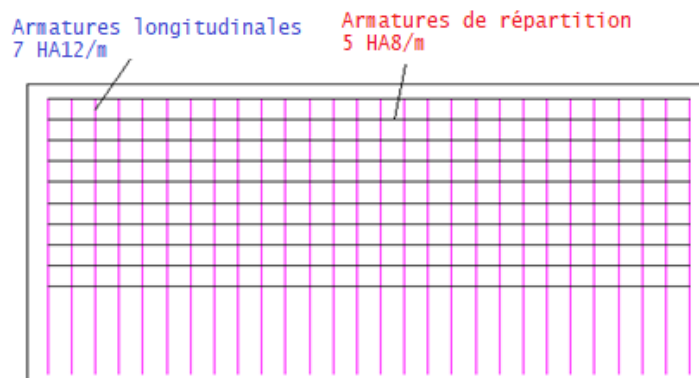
Vue en plan du ferrailage du balcon selon le CBA 93.
